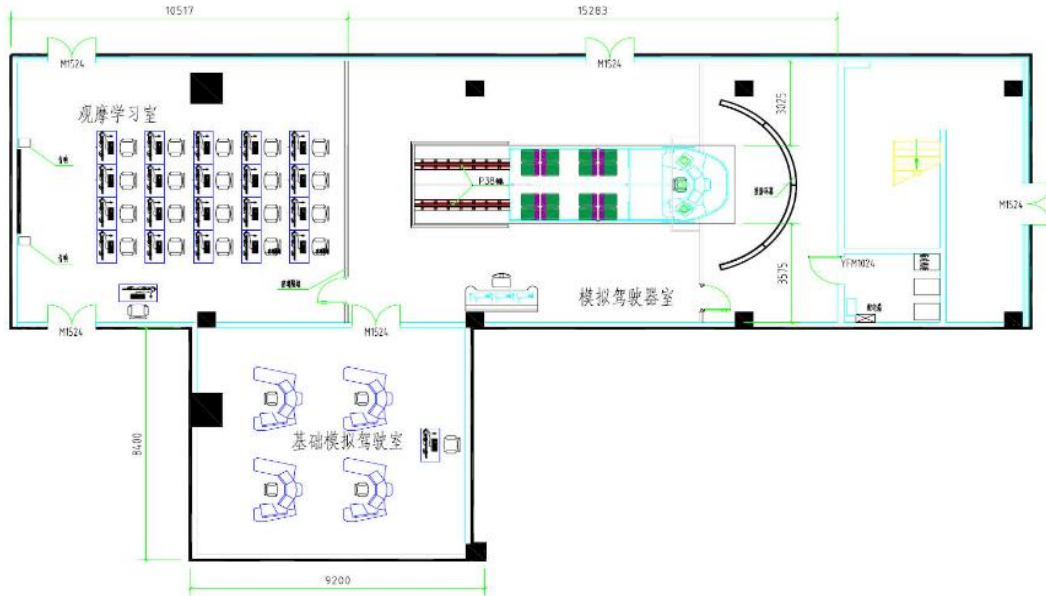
车辆驾驶仿真培训系统设备平面布置图
